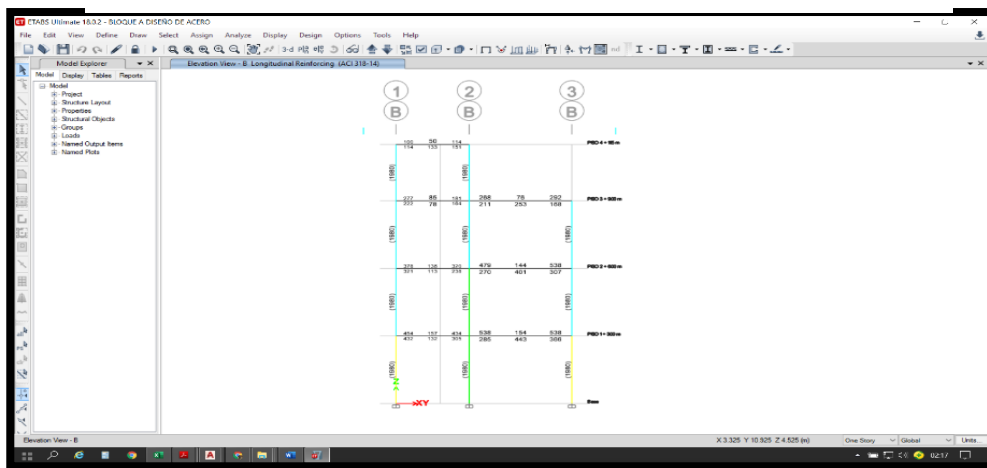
Bloque A - Acero longitudinal en el eje elevación eje B-B
